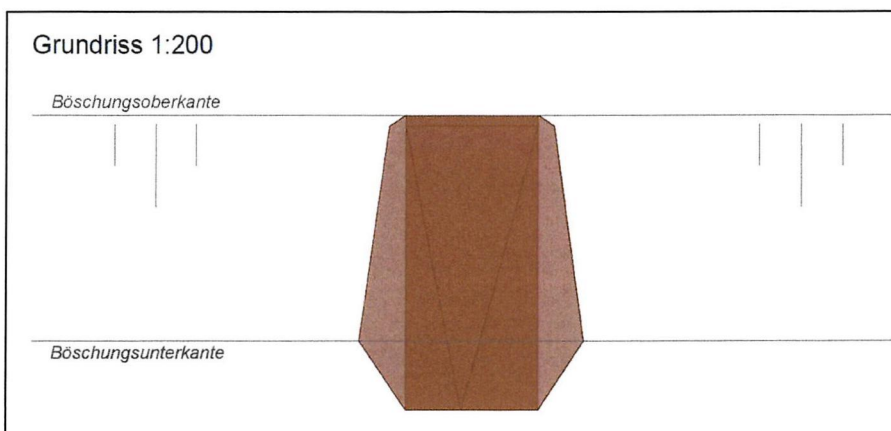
Grundriss Abfahrtsrampe für Raupenbagger in die Wiese
